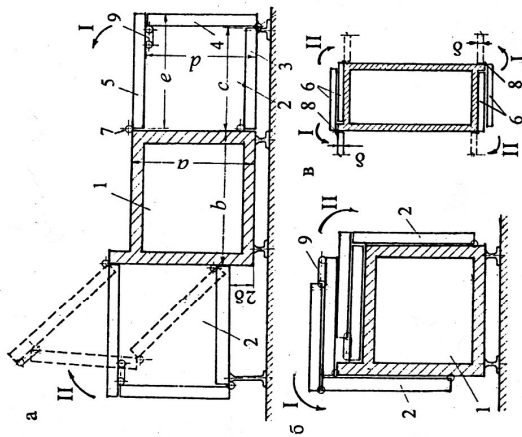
Контейнерное трансформируемое здание с боковыми отсеками
